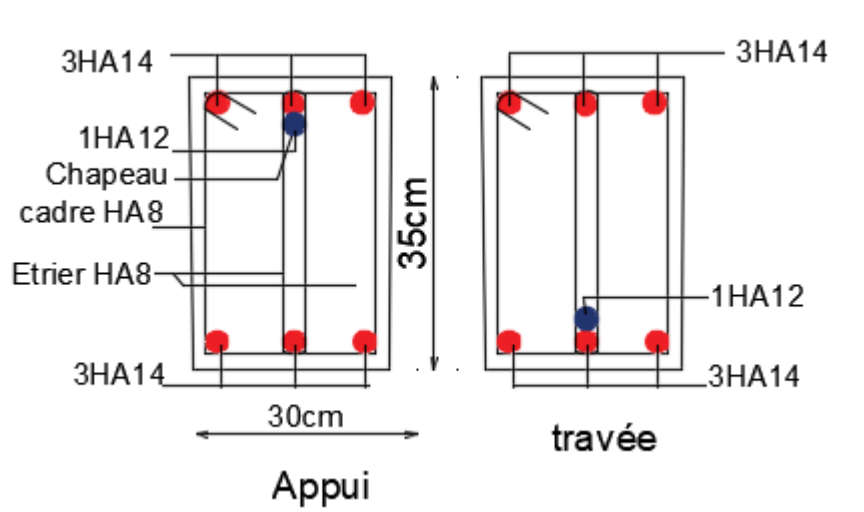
Schéma de ferrailage de la poutre secondaire sous-sol
